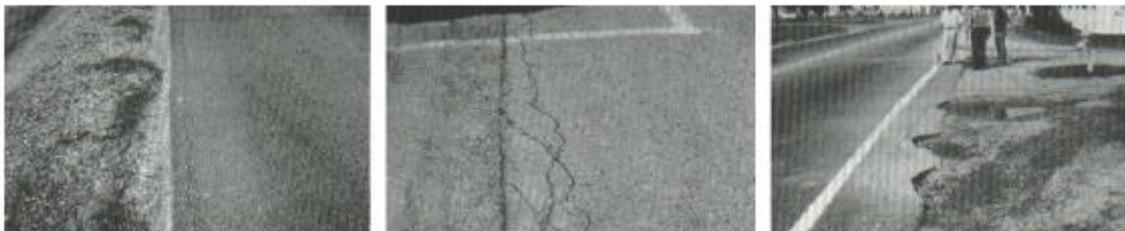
Falla de tipo grieta de borde.
